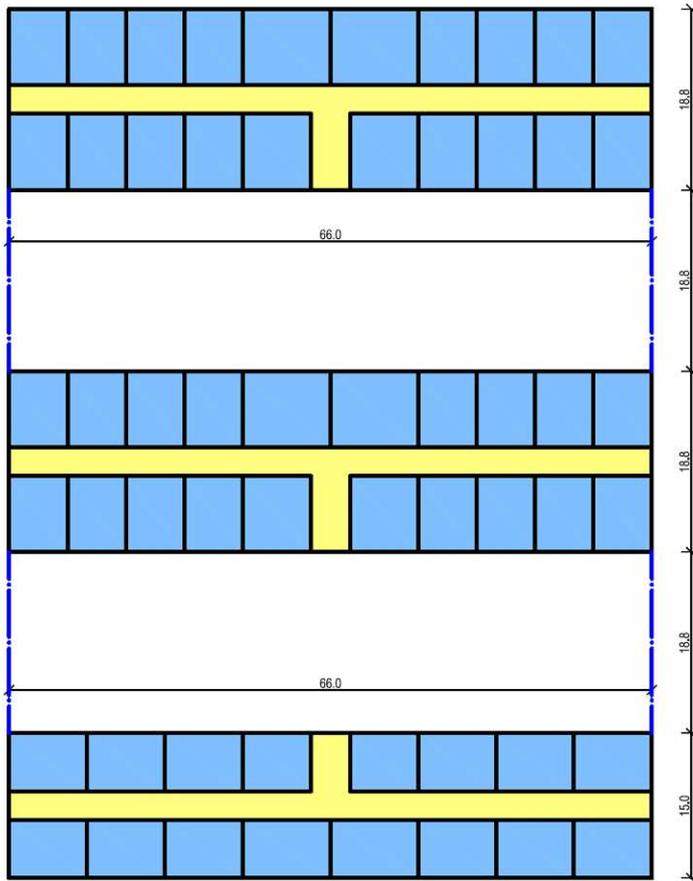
Skizze Regelgeschoss Barbara-Prammer-Allee; 1220 Wien
